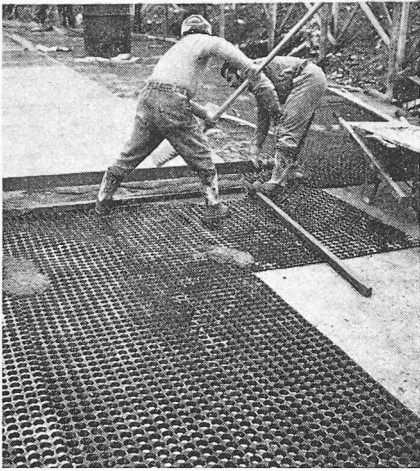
Einbau der Drainageschicht beim Reaktorgebäude
